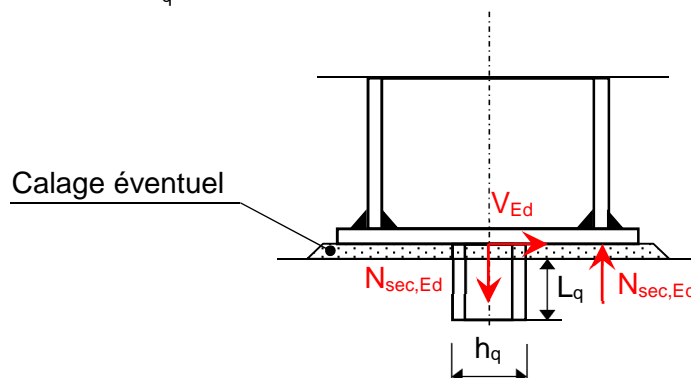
Disposition a) : stabilité de la bêche assurée par des efforts secondaires
